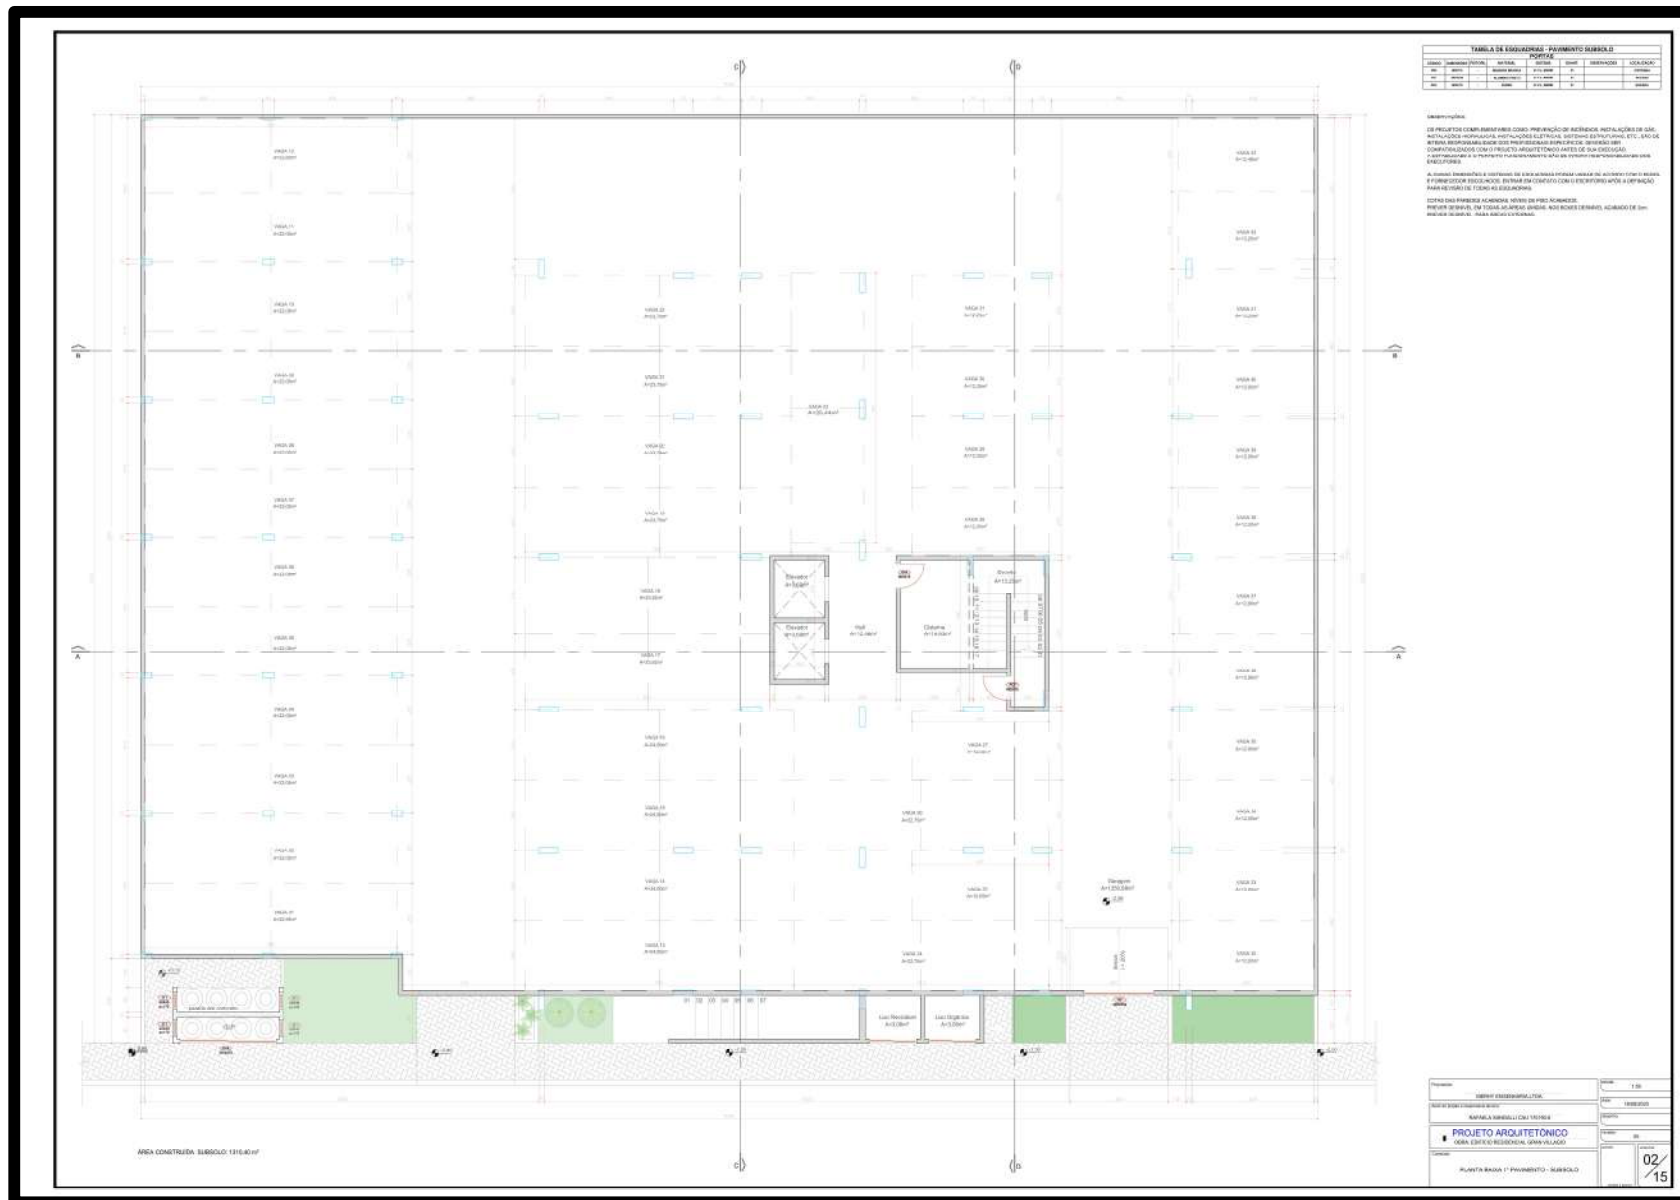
Planta pavimento subsolo. Fonte Construtora Merhy (2020).
